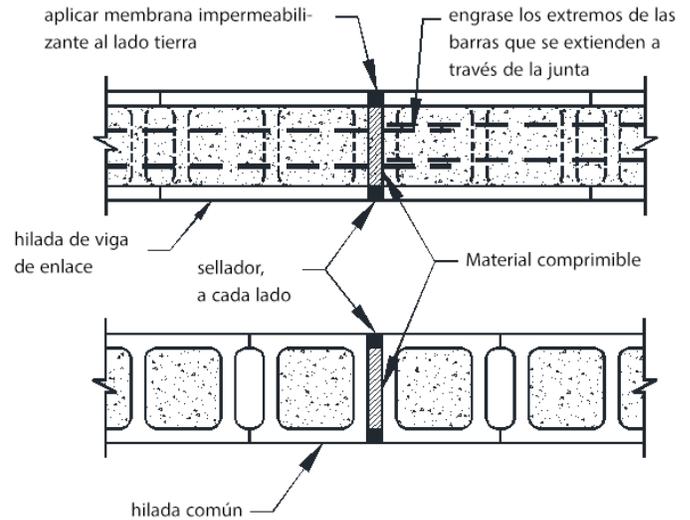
DETALLES DE JUNTAS DE EXPANSIÓN PARA MAMPOSTERÍA
